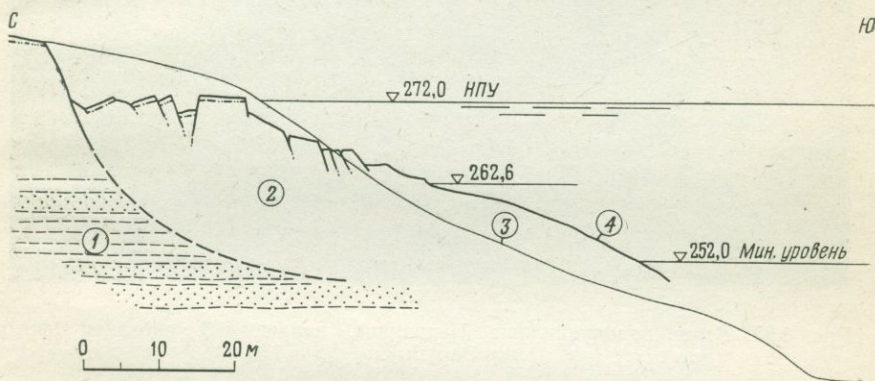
Разрез оползня на водохранилище Нехранице после снижения уровня воды на 20 м.
